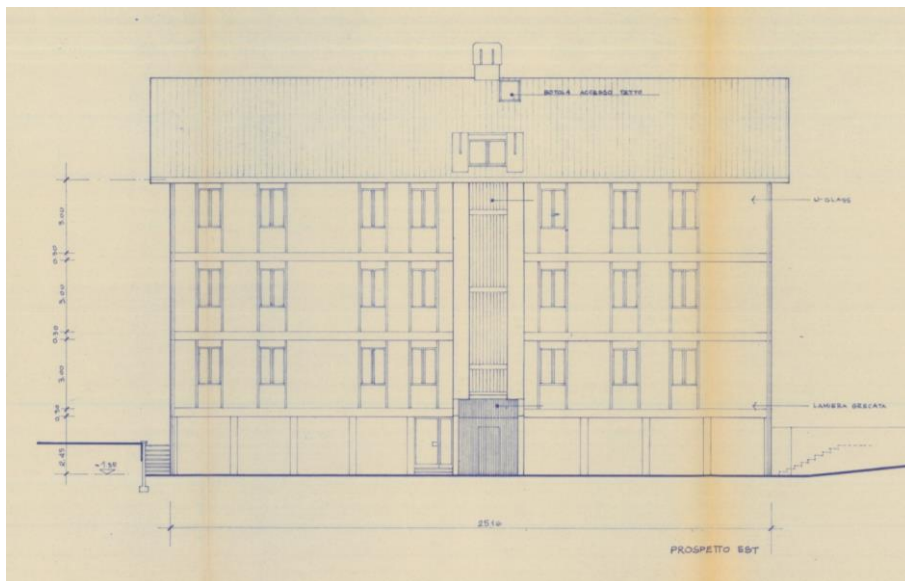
, Prospetto Nord-Est, scansione progetto originale
